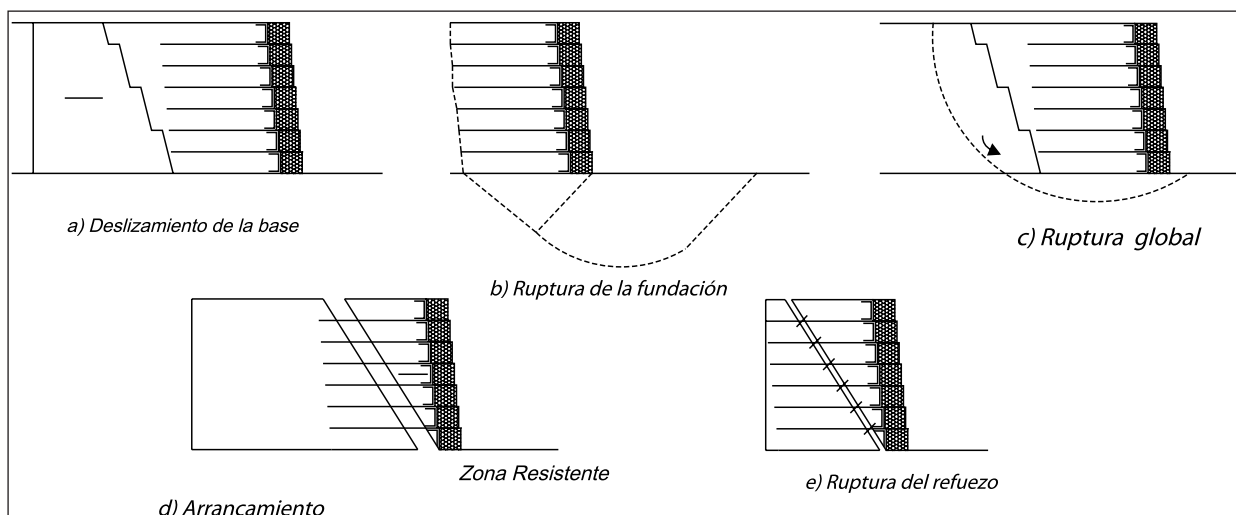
Estabilidad interna de un muro en suelo reforzado.
